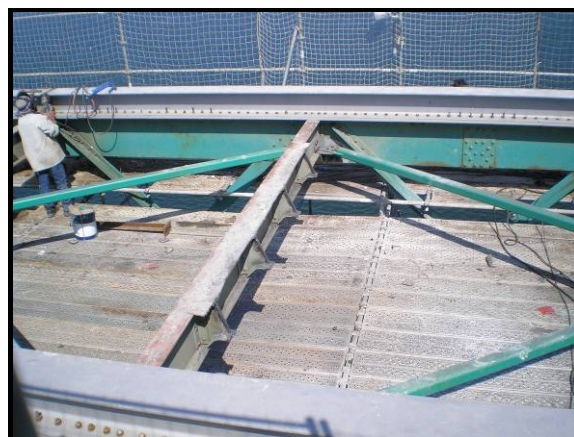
Contraventamento instalado antes da remoção do pavimento
